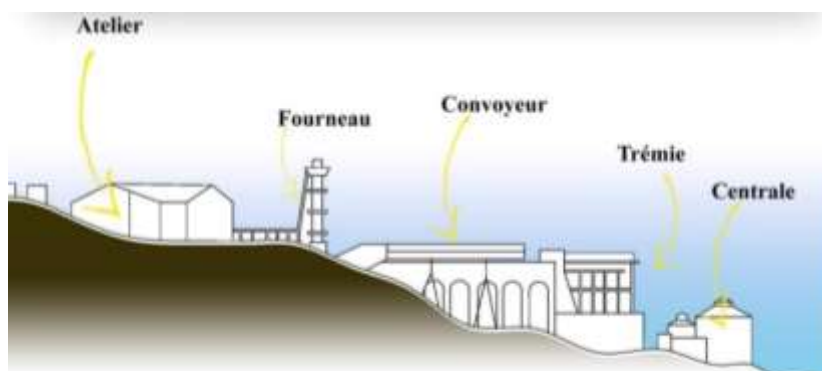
Coupe-façade transversale schématique des installations et engins du carreau de la mine de Djerissa
